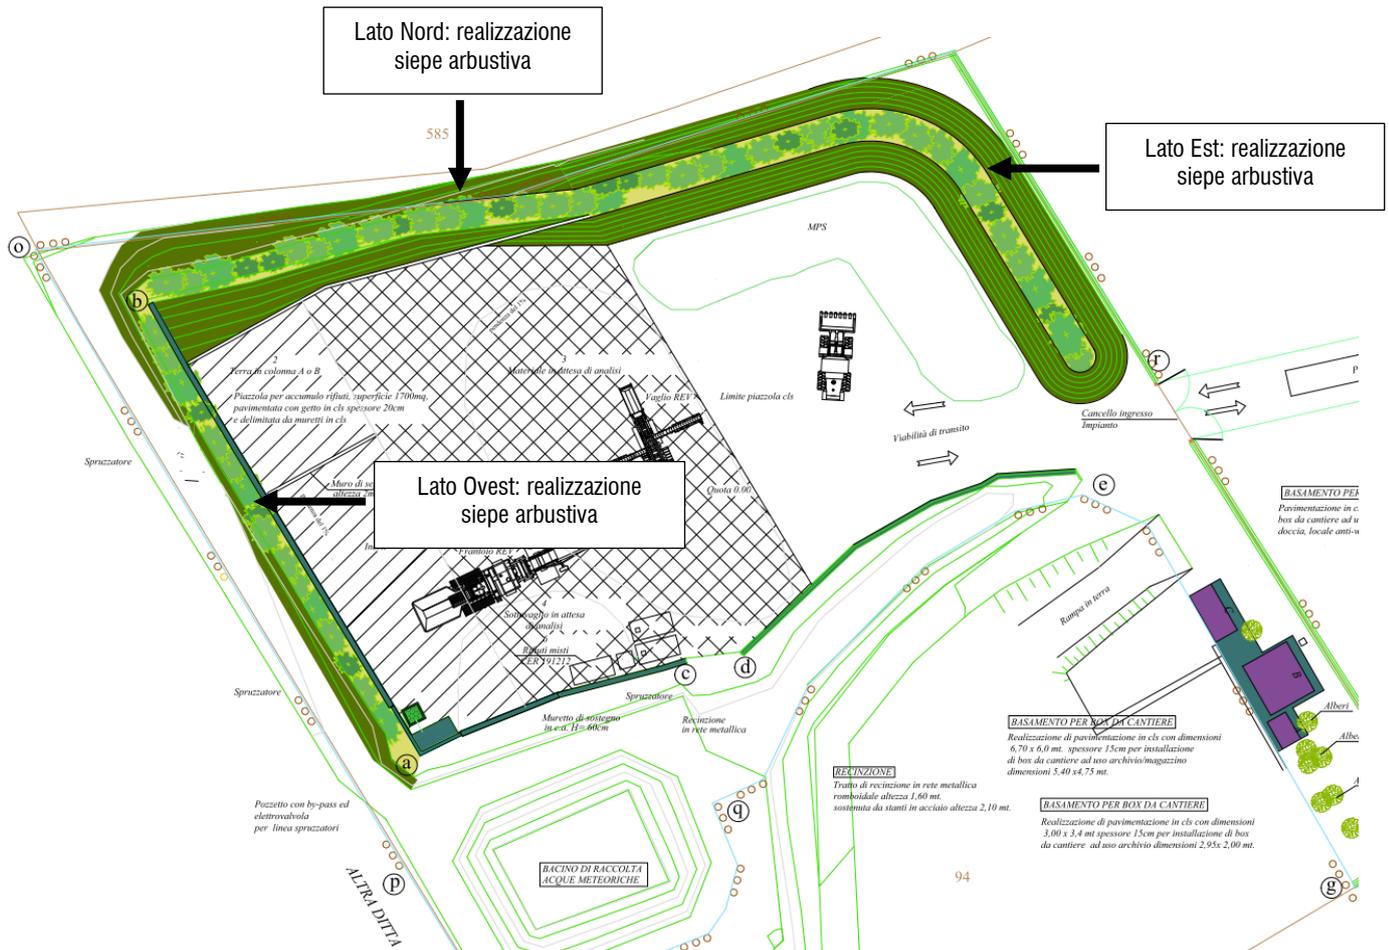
Layout aziendale con individuazione delle arginature perimetrali oggetto di sistemazione.
